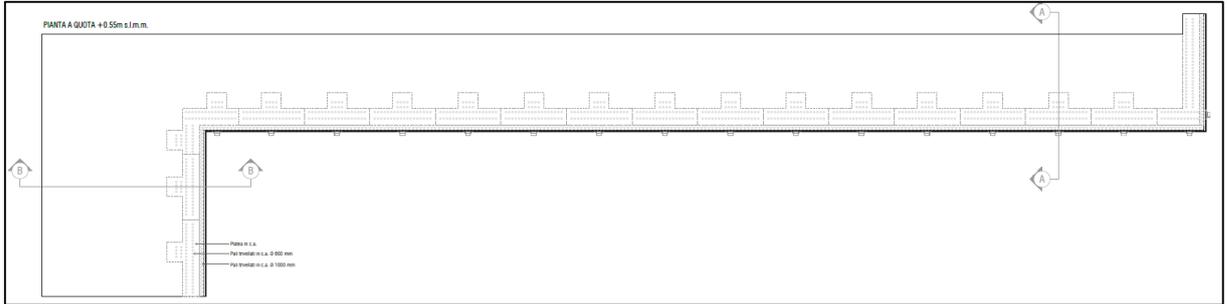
Banchina di progetto – Pianta a quota + 0,55 m s.l.m., delle piastre di collegamento pali (Elab. EG.09)
